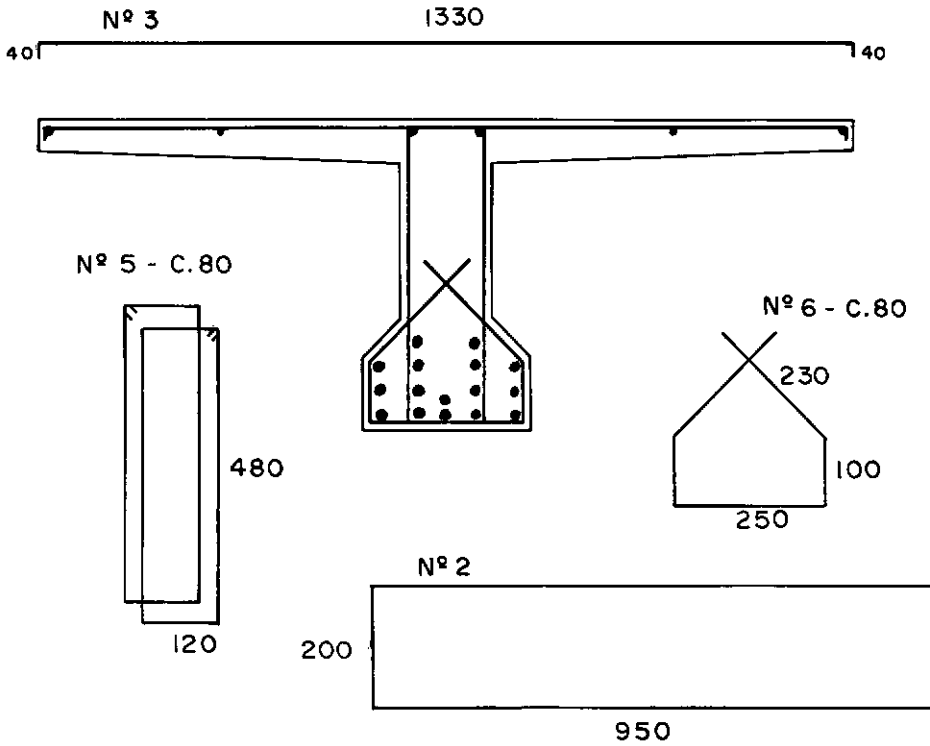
Dimensões nominais das vigas ensaiadas -
